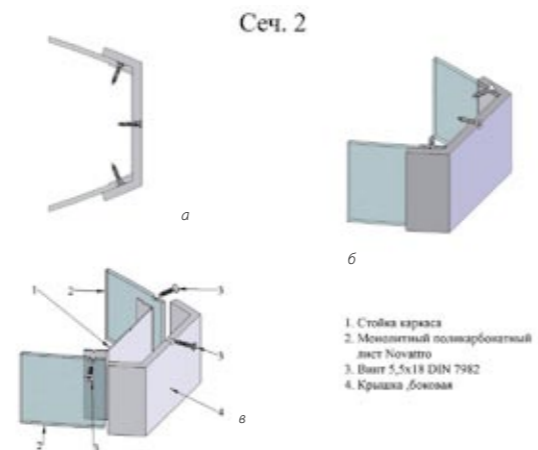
Узел соединения листа из поликарбоната к боковой части конструкции светового короба: а – двухмерное изображение узла, б – трехмерное изображение узла, в – схема сборки узла.
